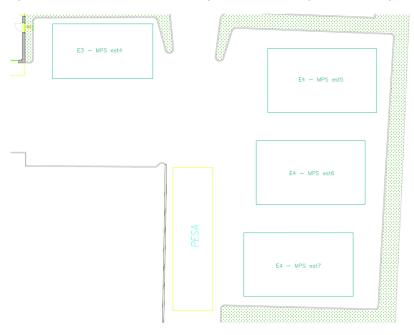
Planimetria delle aree esterne di stoccaggio E3 ed E4 allo stato approvato
